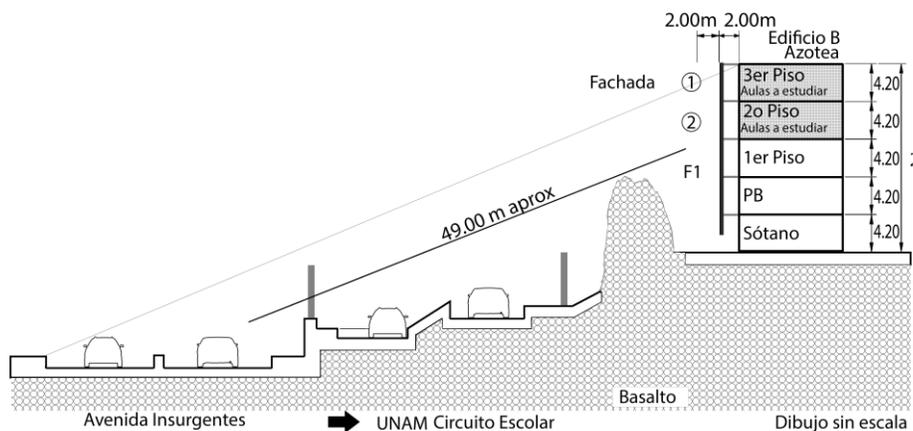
Colocación de fachada de doble piel en el edificio "B".
